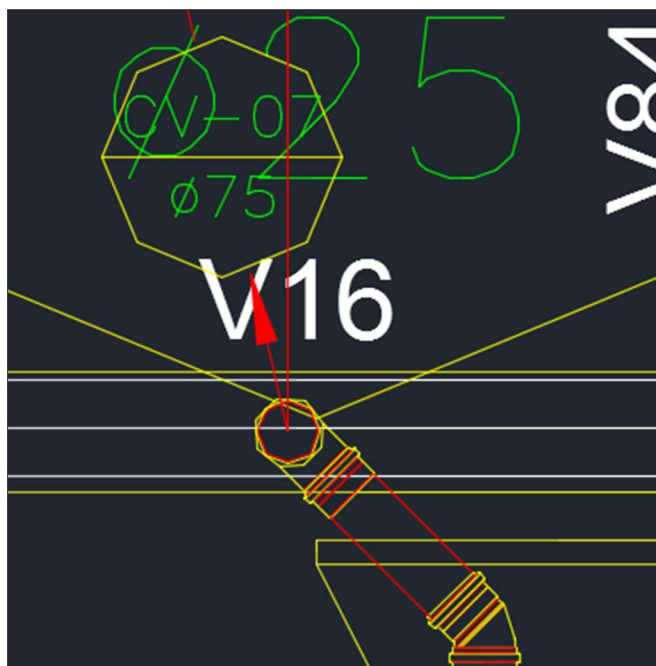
Interferência nº 1. Coluna de ventilação com viga
